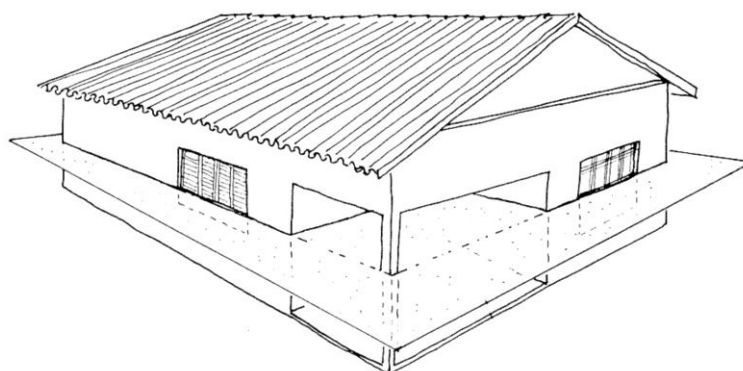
Plano de secção horizontal para obtenção da planta-baixa.
